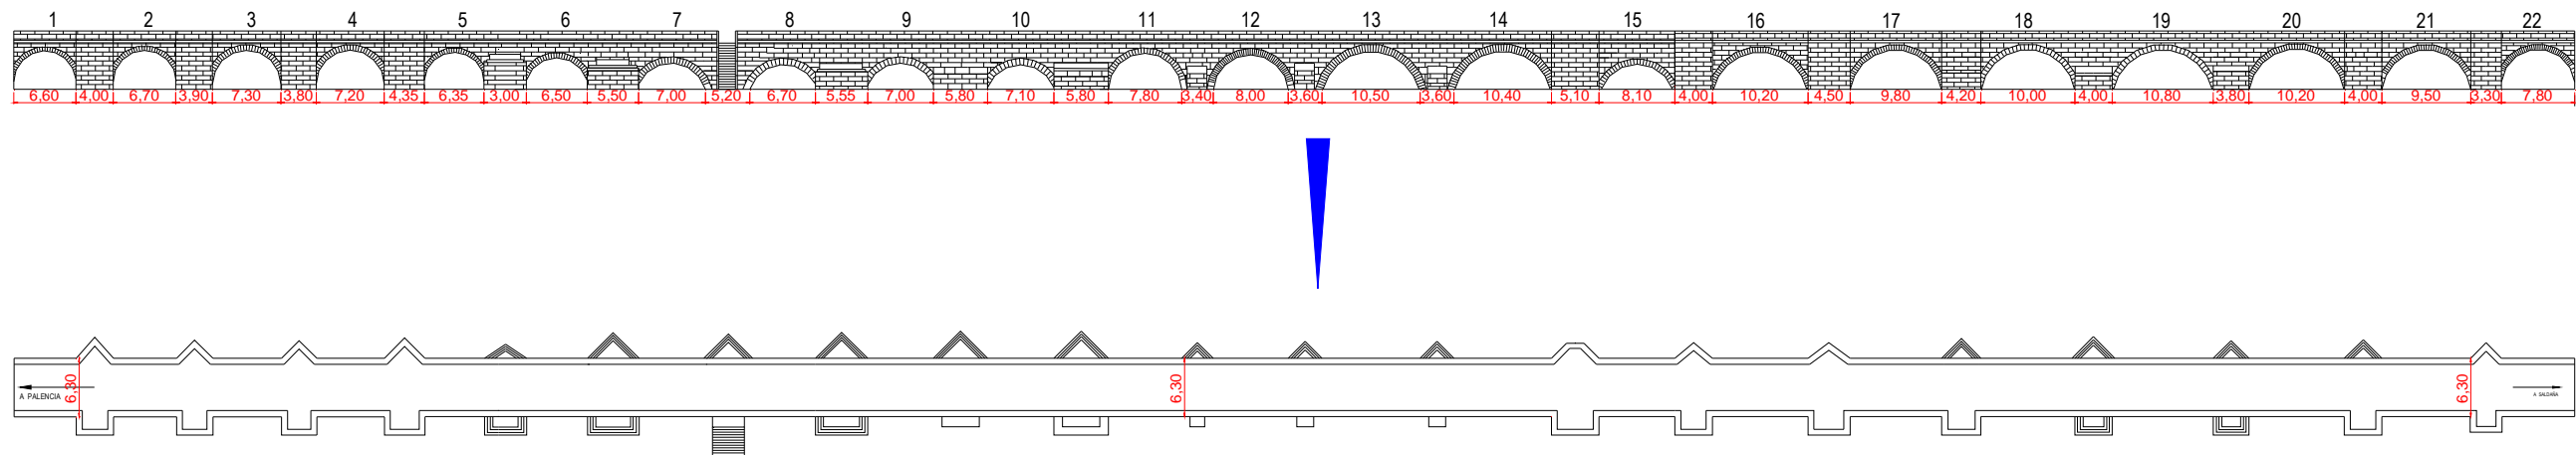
Dibujo de planta y alzado en puente en Saldaña.
